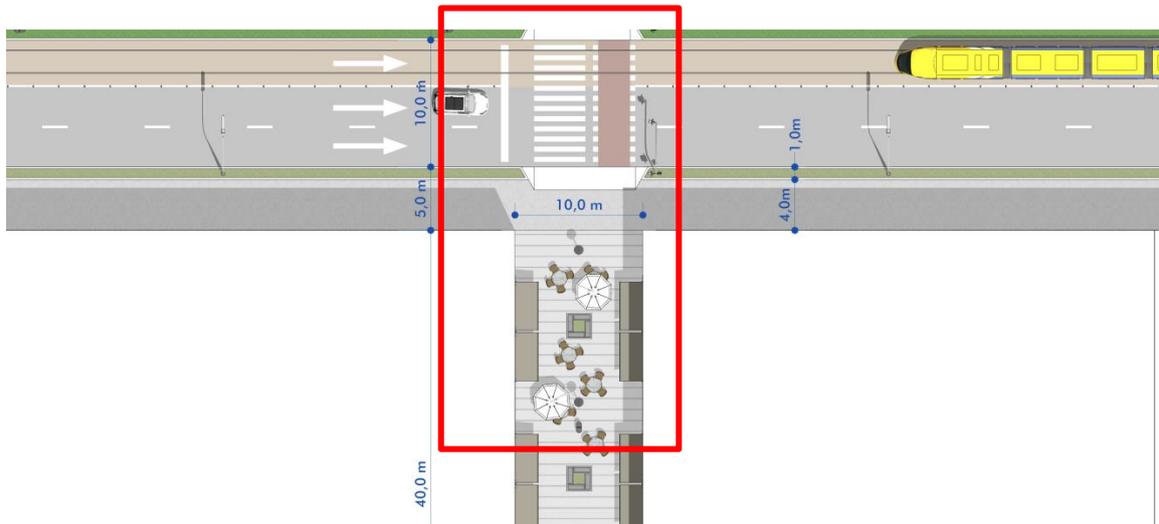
“Becos” entre prédios comerciais, ASA SUL - Planta baixa.
